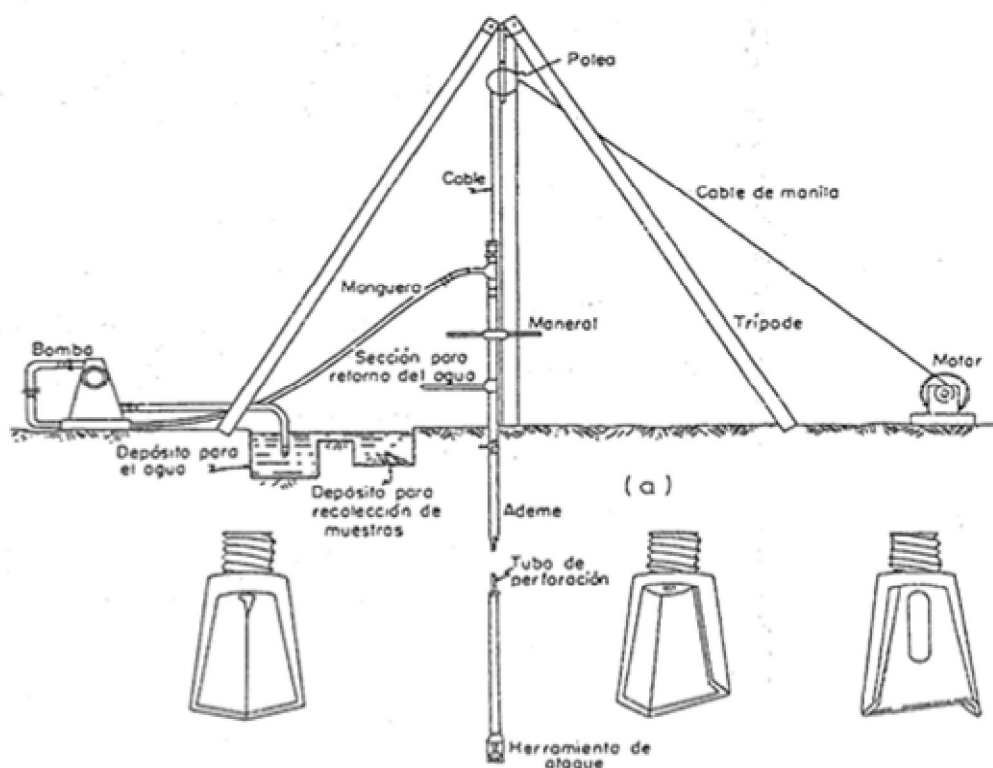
Dispositivo para el sondeo por lavado a) Conjunto, b) Barrenos de perforación.
